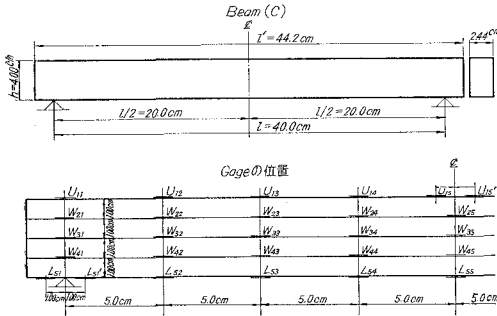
鋼矩形断面桁模型 Beam (C) の寸法及びゲージの位置
